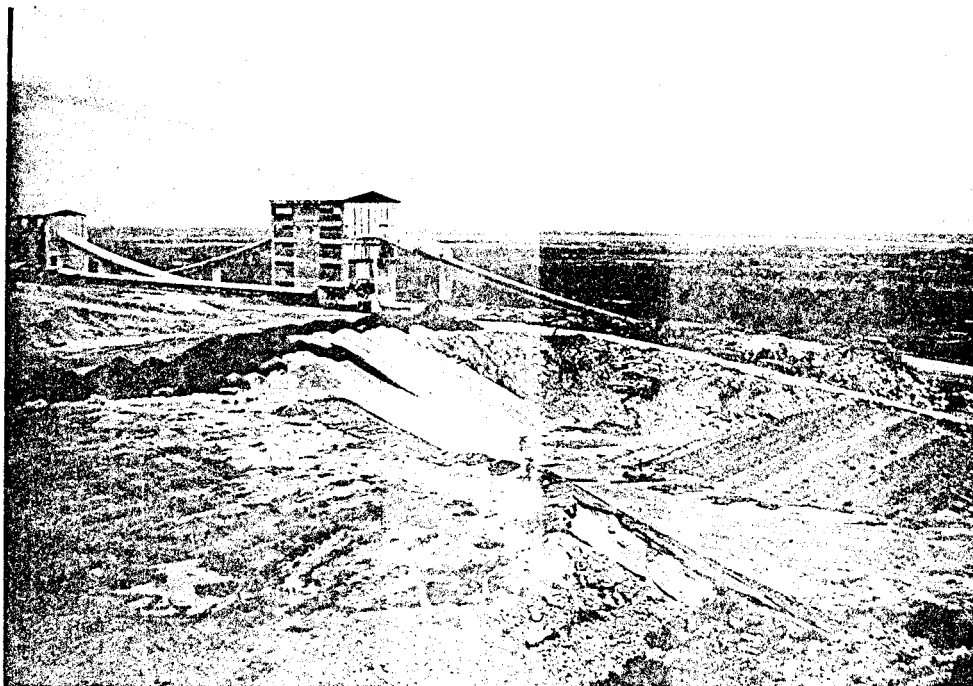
VISTA EN LA DIRECCION 1-3 DEL MEDIDOR DIRECCIONAL
